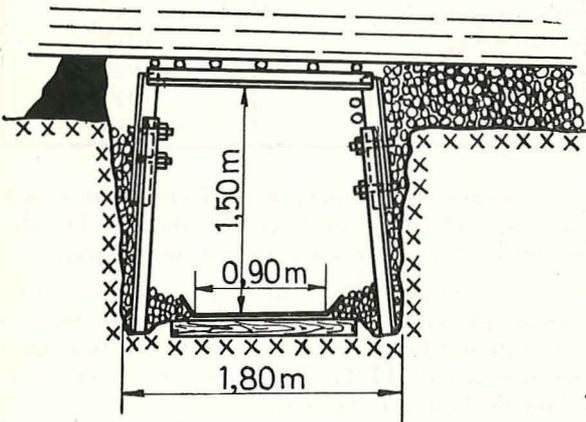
Coupe dans une voie de niveau intermédiaire (voire de raclage) avec soutènement en portiques.
